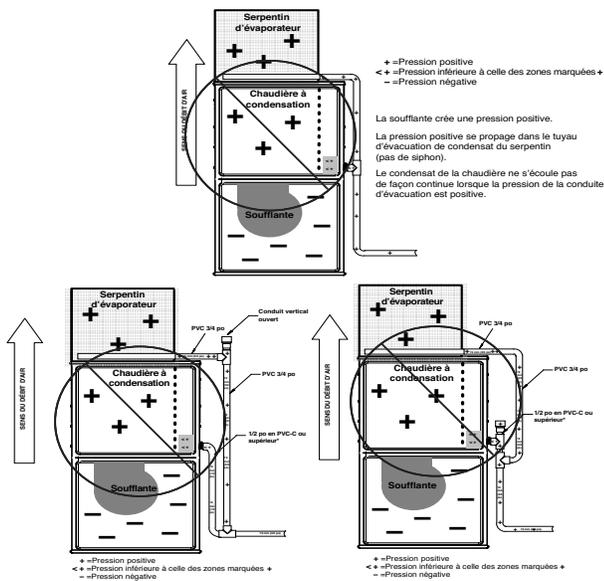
Exemple de fixation au tuyau d'évacuation sur place (non autorisée)
